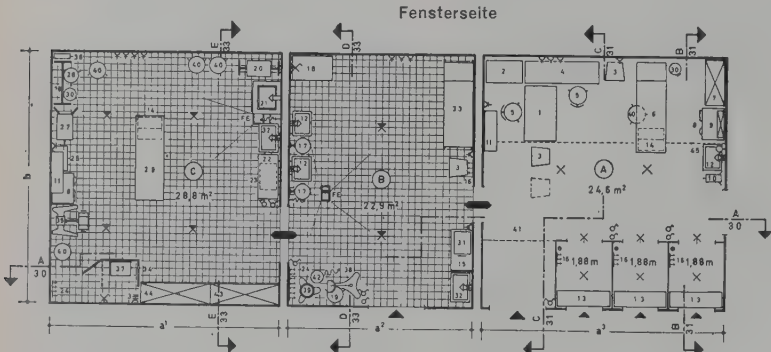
Raumgruppe Orthopädie — Grundriß 1:150
